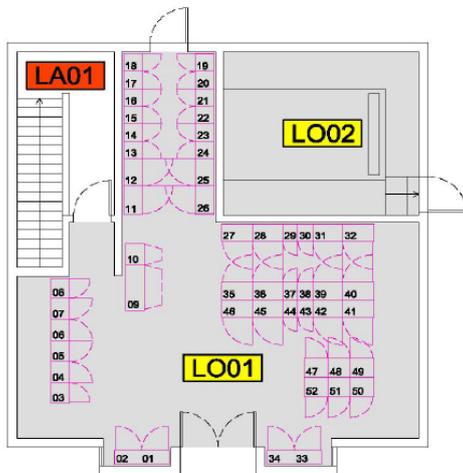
Armadi elettrici da 11 a 26 decantazione finale e pompe di ricircolo
